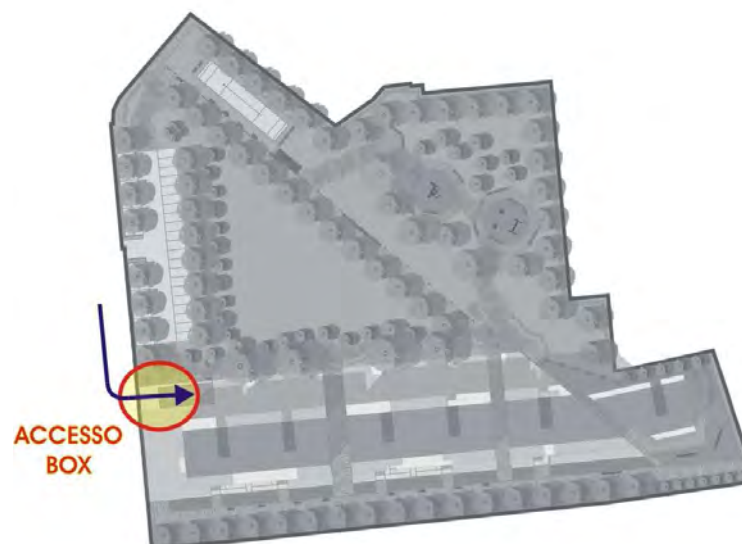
PII San Faustino – Identificazione rampa di accesso al piano interrato
